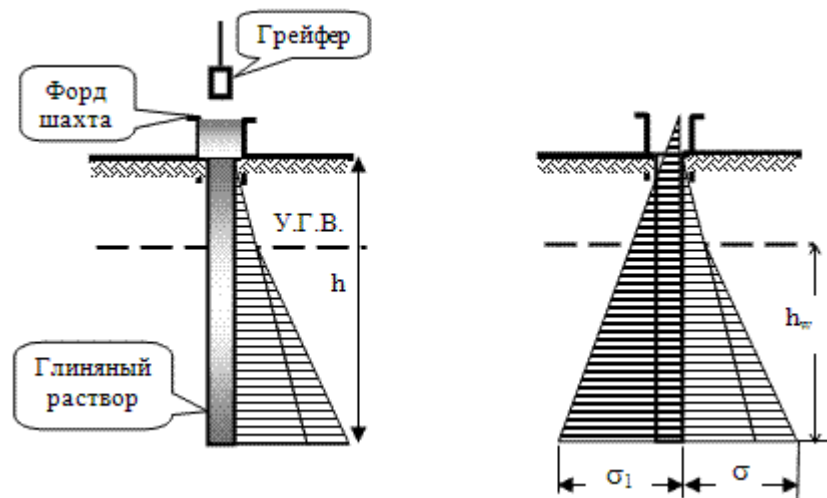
Схема пристрою стіни в ґрунті з побудовою епюр бічного тиску ґрунту і бентонітової розчину глини на вертикальну стінку траншеї
